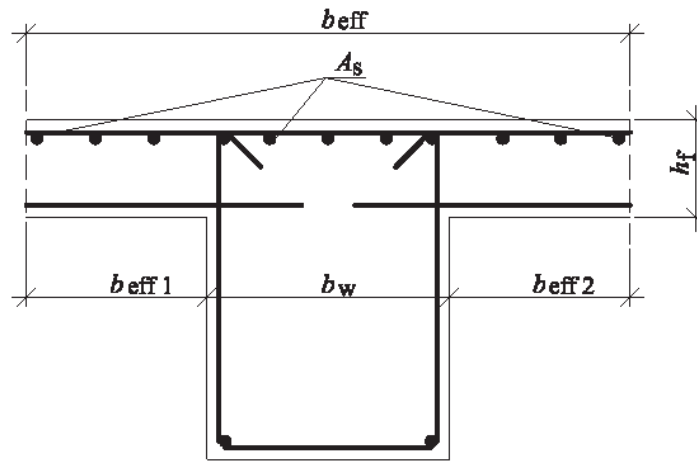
Розташування верхньої арматури на проміжних опорах нерозрізних балок
